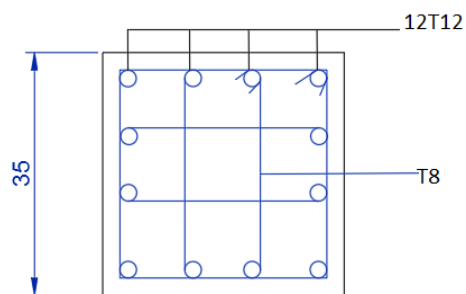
Schéma de ferrailage des poteaux(35;35)
